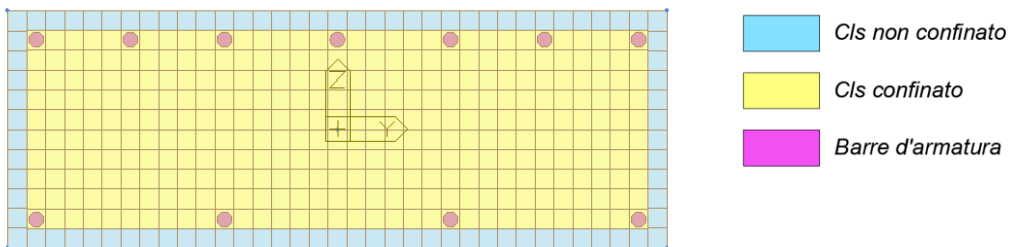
Sezione a fibre TR_T1 (estremità)
